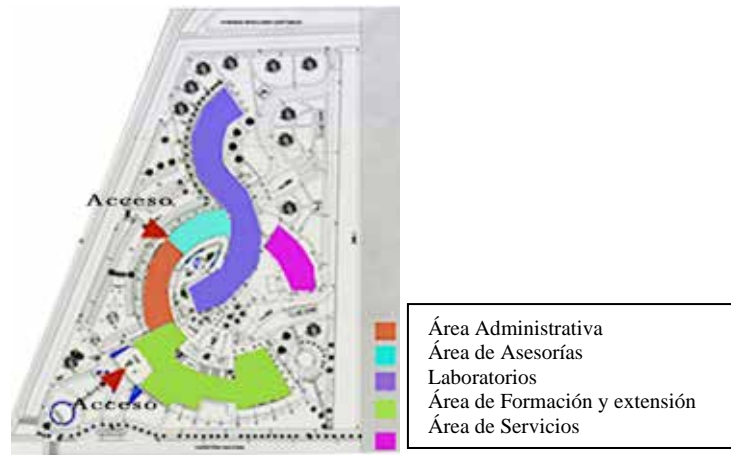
Esquemas de áreas Planta Baja. Fuente: Arzola A. (2019).
